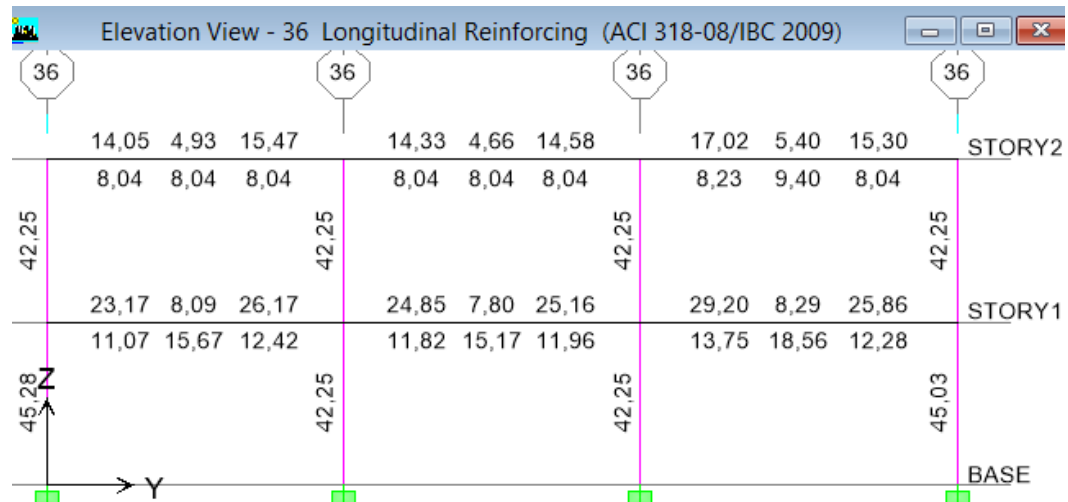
Acero en Vigas y Columnas en el Pórtico 36 – C. Quirúrgico- (NEC-11)
